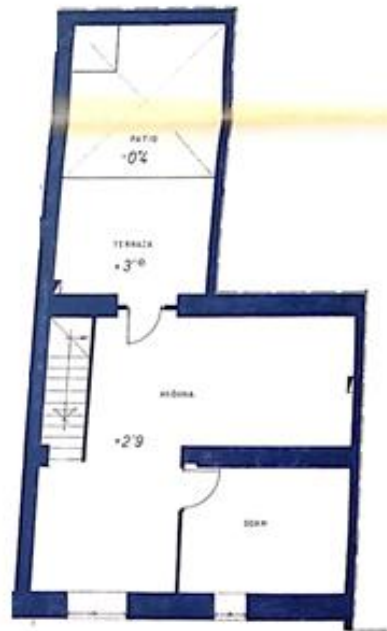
Plano planta primera vivienda 1. Junio 1984.
